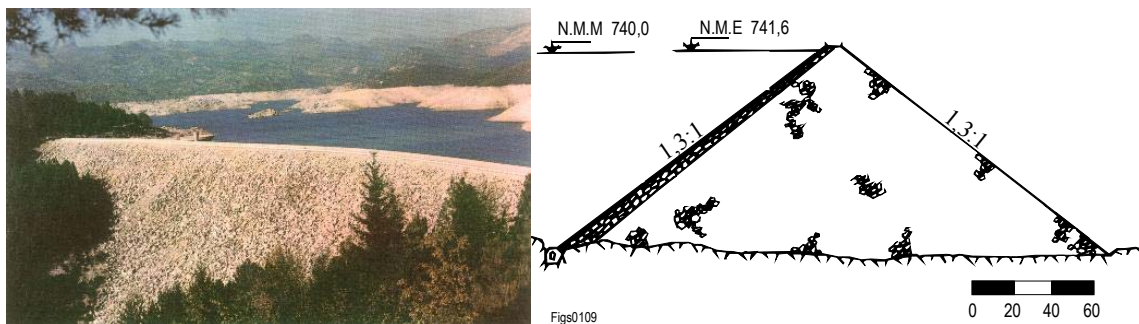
Barragem de Paradela. Vista de jusante e perfil transversal tipo
